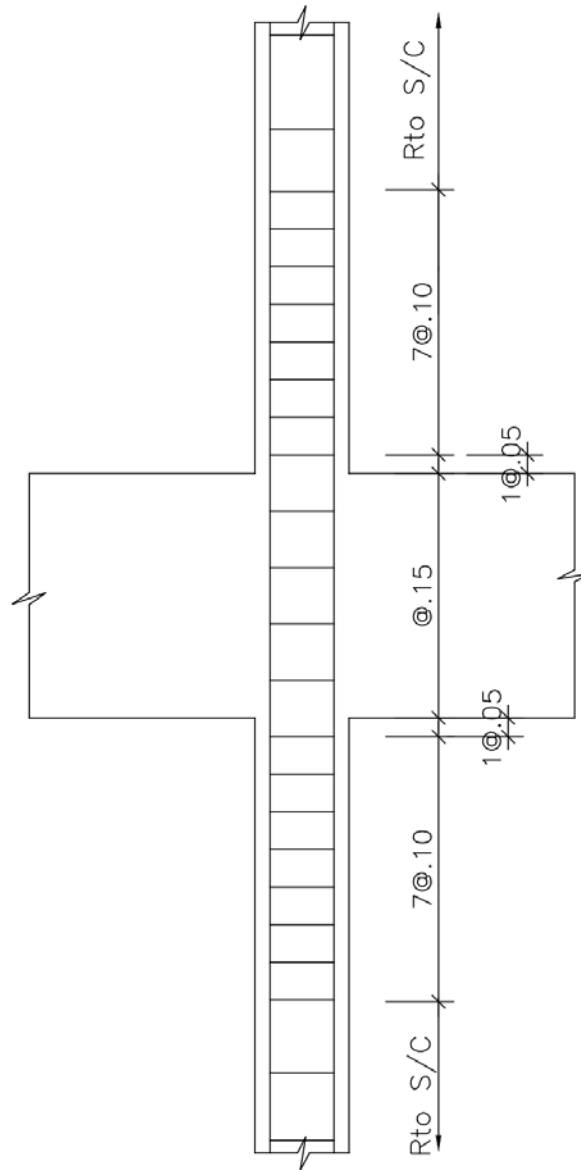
Detalle de refuerzo Transversal de columnas
